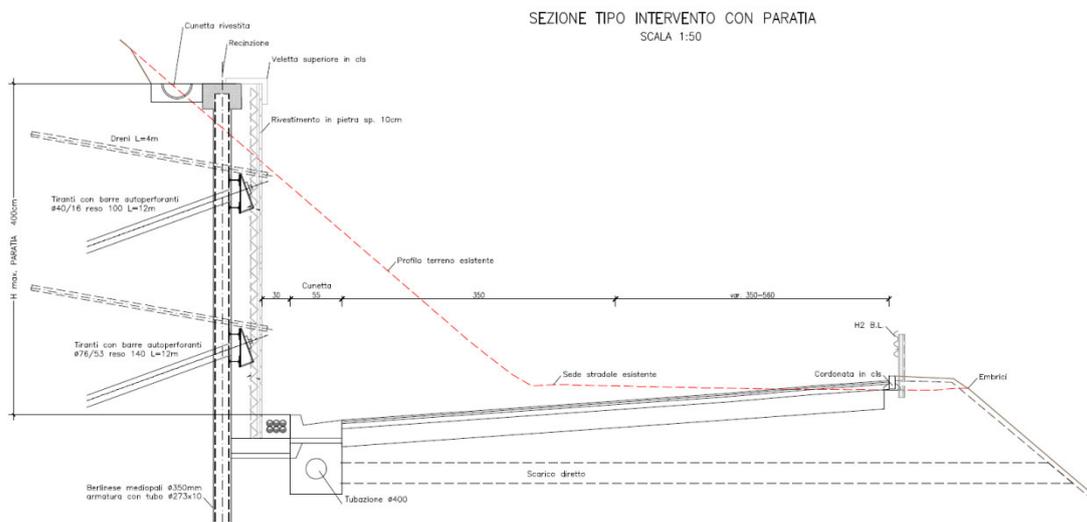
Sezione stradale tipica con realizzazione di berlinesi tirantate rivestite in pietra.
